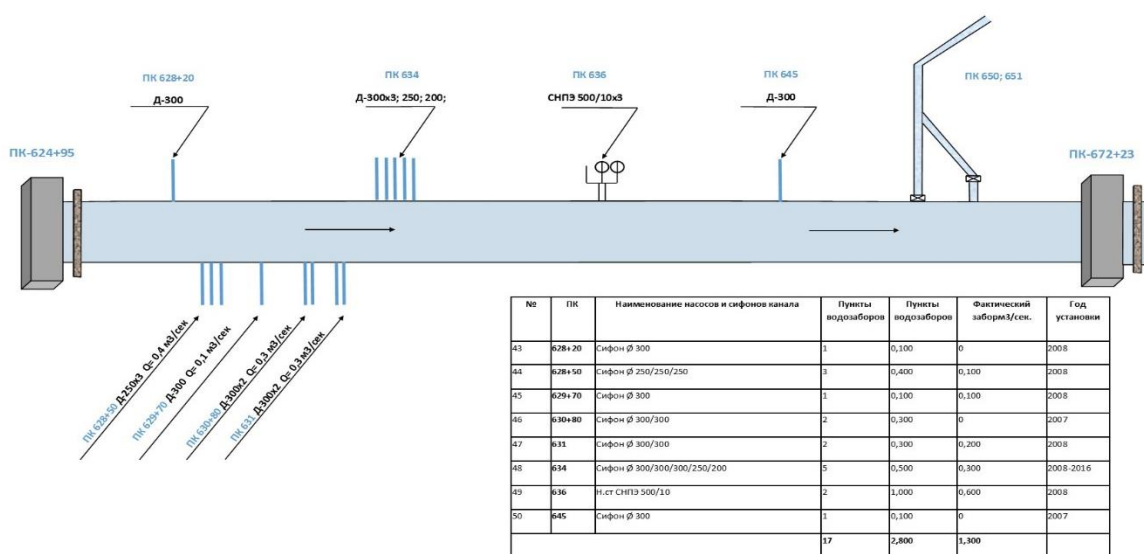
Схема бетонного канала между НС- 4 и НС – 5.
